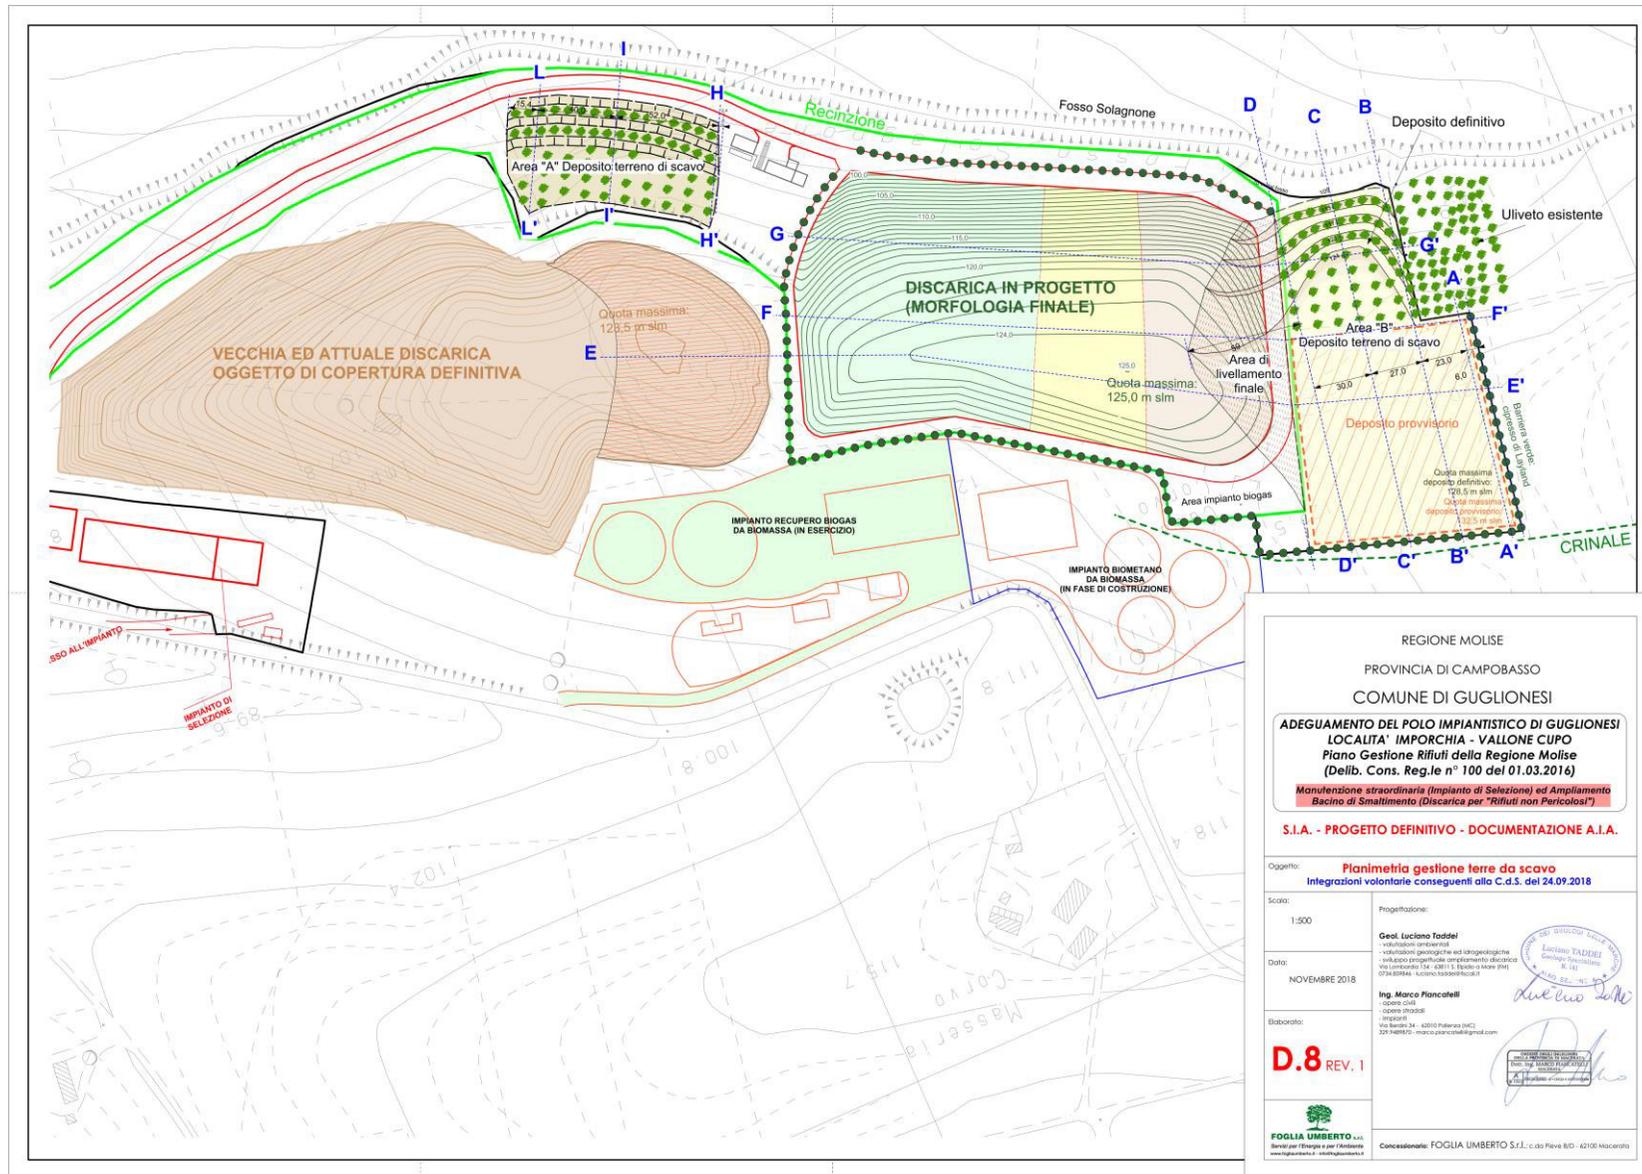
planimetria generale con indicazione della gestione delle terre e rocce da scavo: assetto "post operam"
